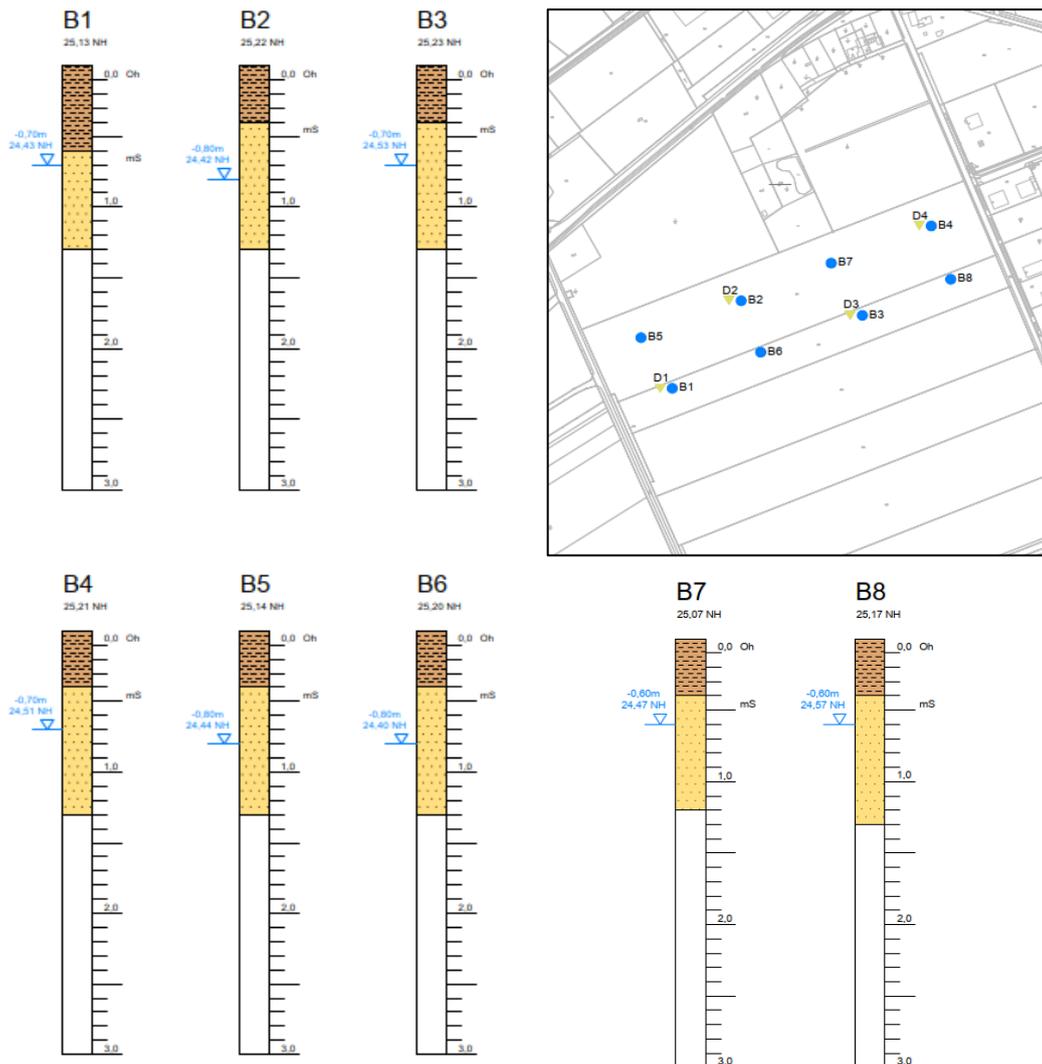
Lageplan und Schichtenprofile. IPW mit Darstellung der Bohr- und Infiltrationspunkten
